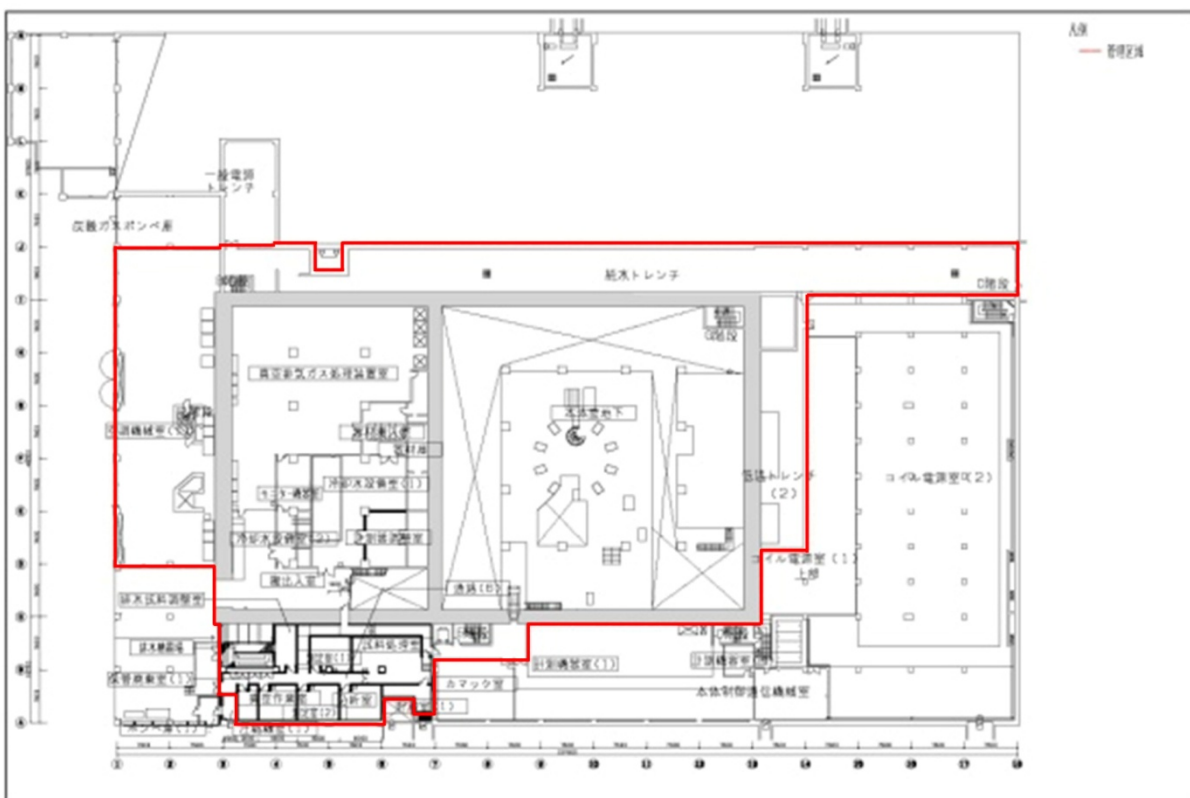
4-2 大型ヘリカル実験棟地下 1 階平面図
